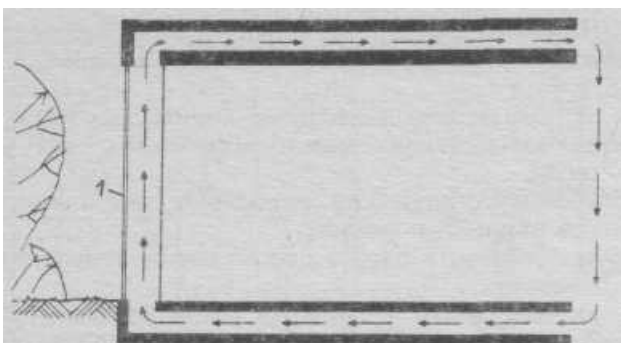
Обогрев окон с помощью специальной циркуляционной вентиляционной системы. Для предотвращения теплопотерь наружное остекление рекомендуется выполнять из теплоизолирующего стекла
